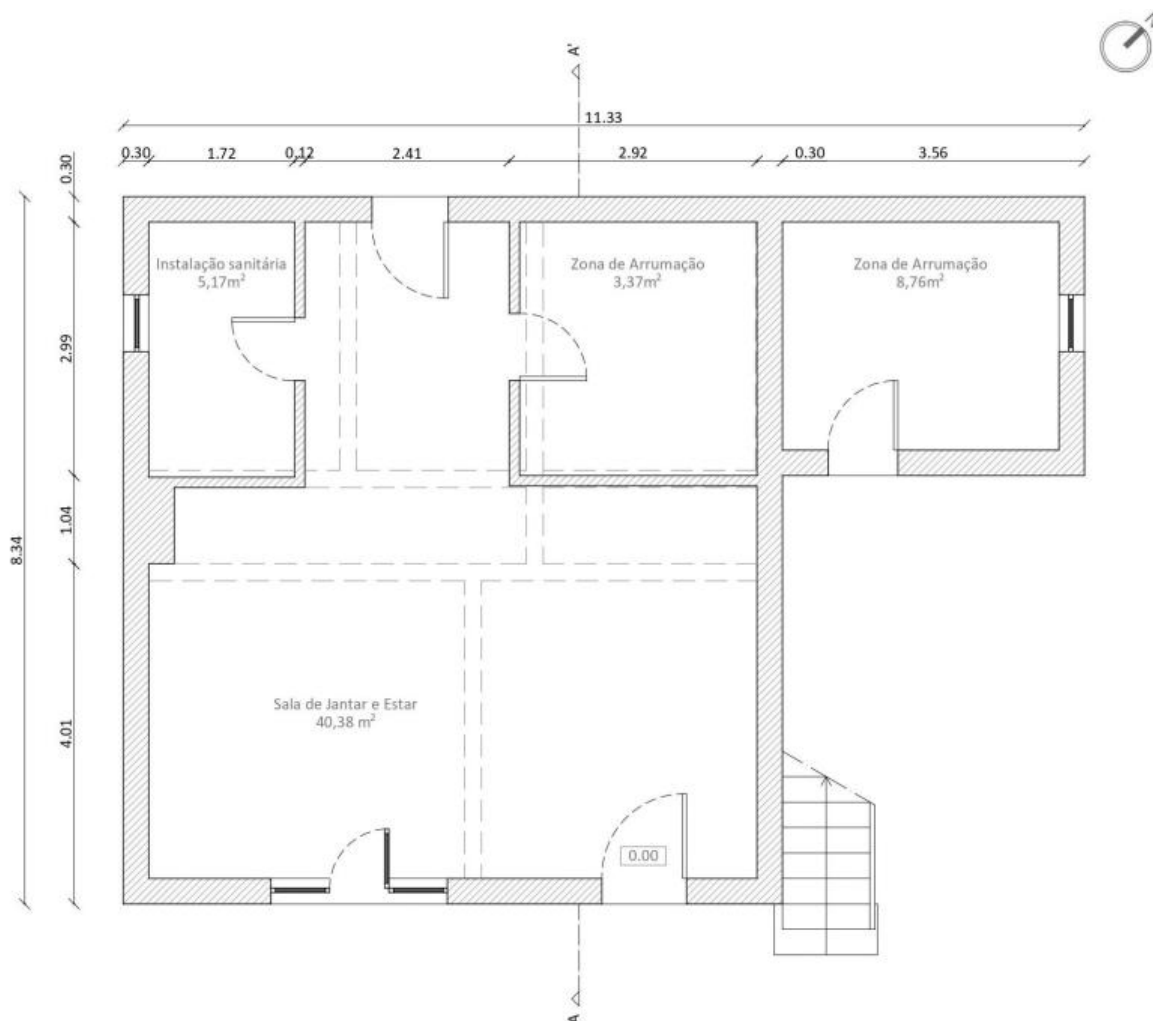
Planta de Levantamento do Piso 0. Fonte: Autor
